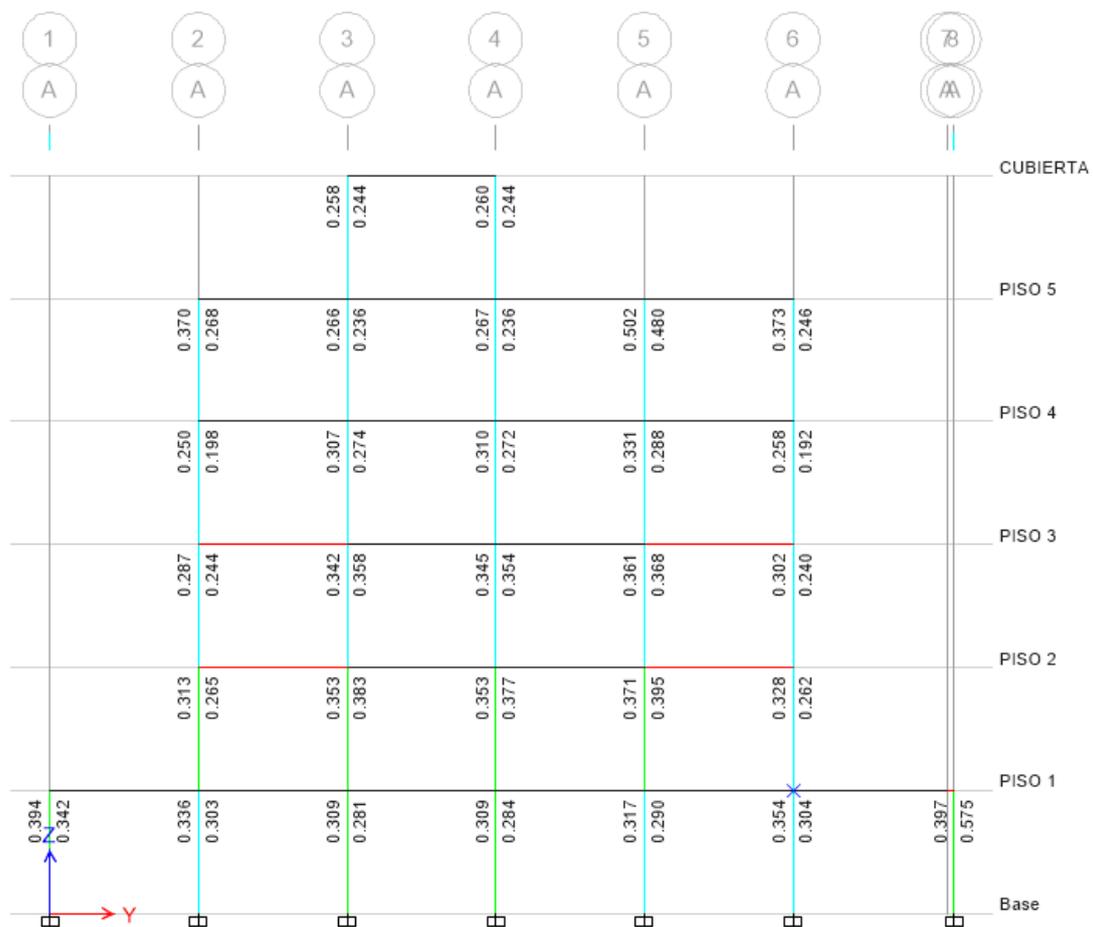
Comprobación de columna fuerte- viga débil. Etabs
